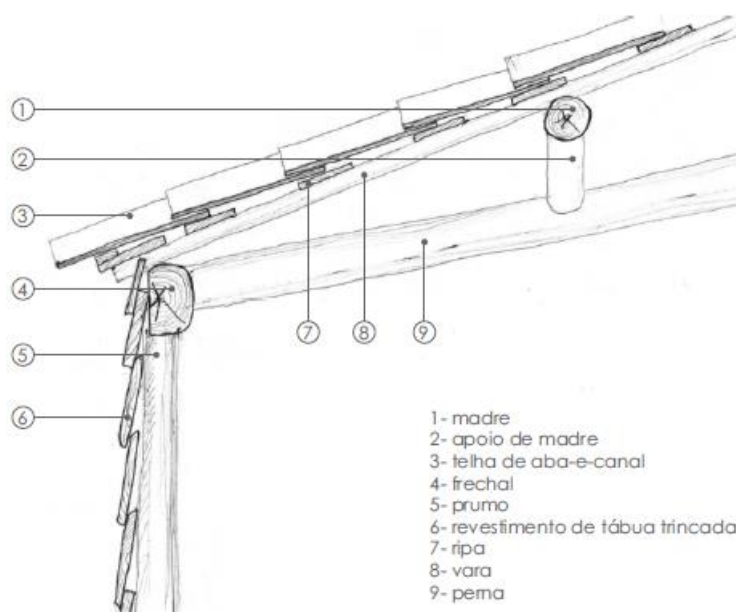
Pormenor tipo de uma cobertura revestida com telha vã (fonte: Moutinho (2007))
